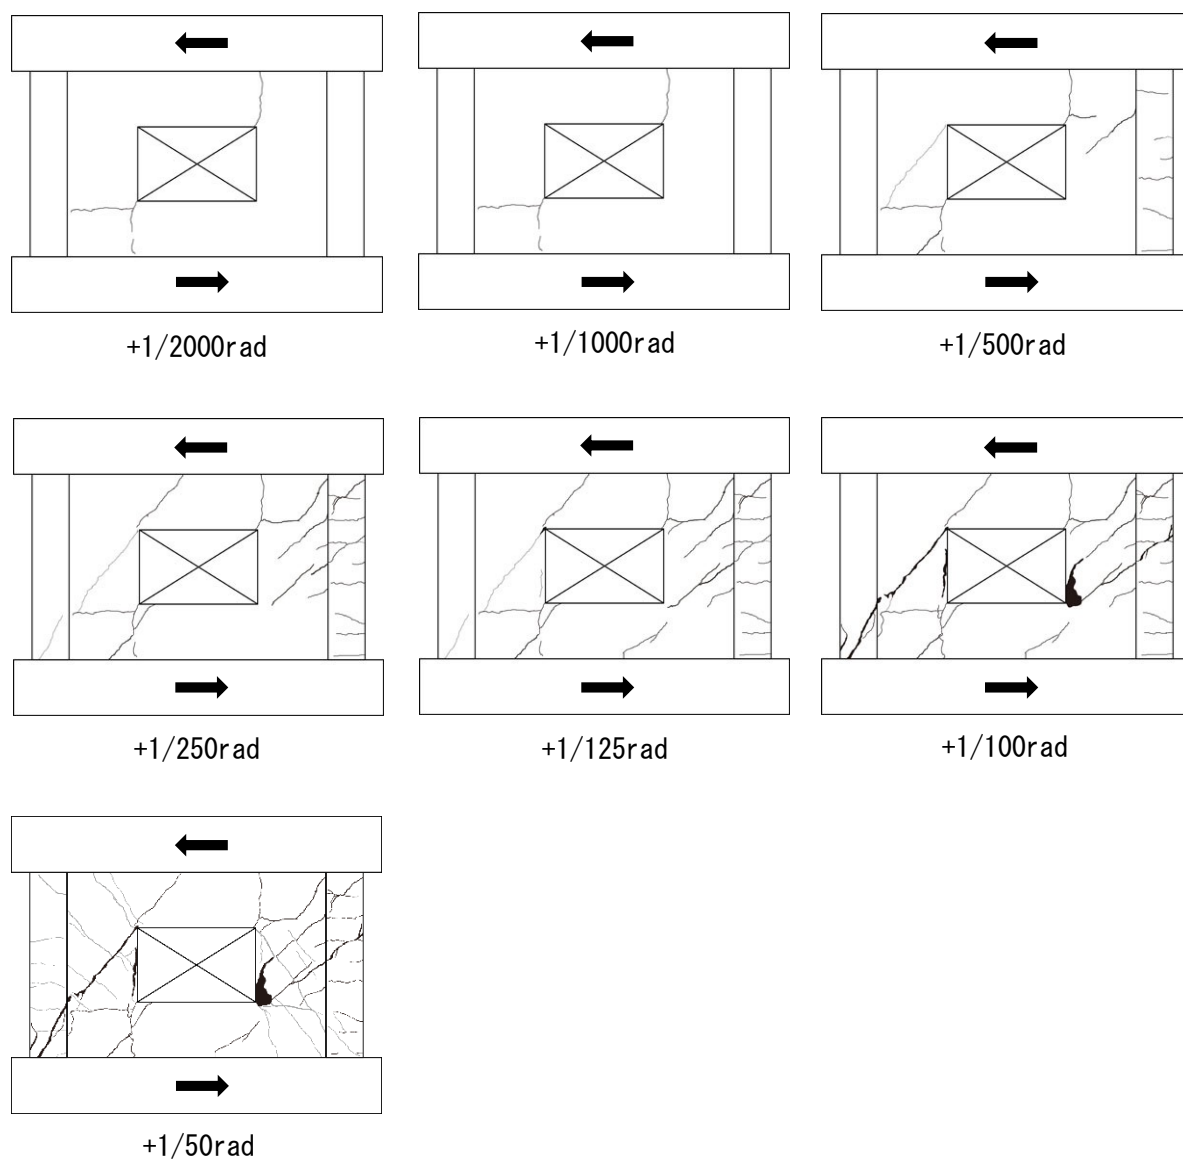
各層間変形角のひび割れ状況図 (F21-SWC-1.5)
